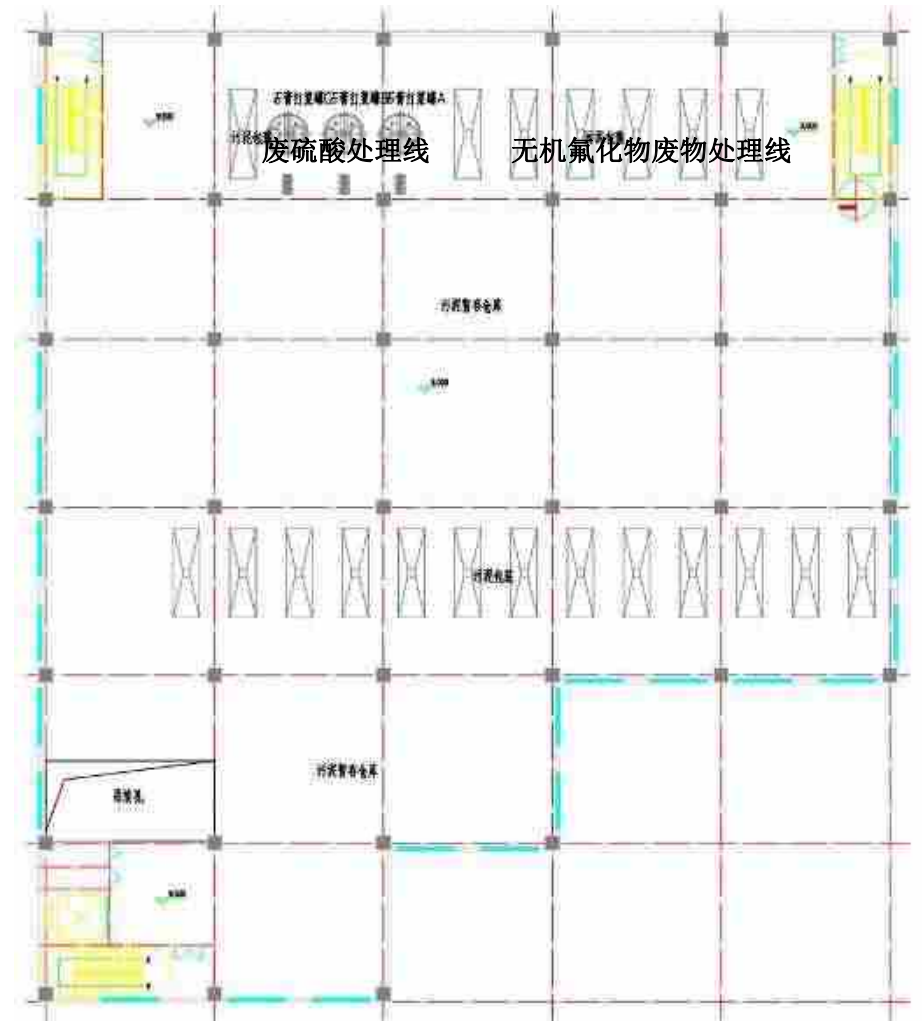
(2) 本次改扩建后 8#\*厂房 2 层平面布置图
